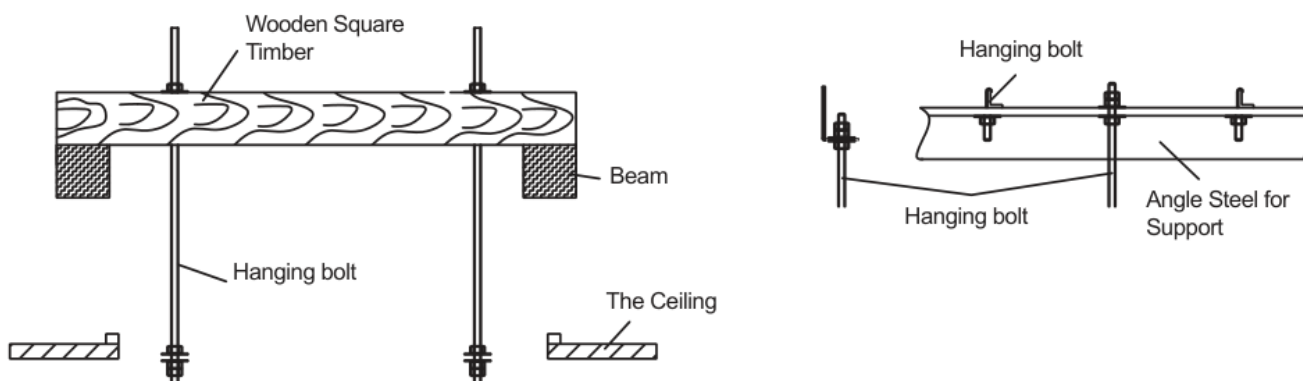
Подвес на деревянном основании и на основании из стального каркаса
